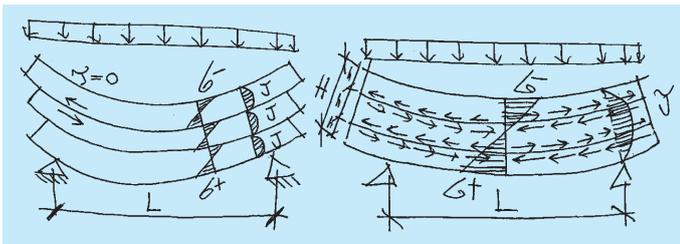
Схема работы балки с раздельной и неразрывной стенками
